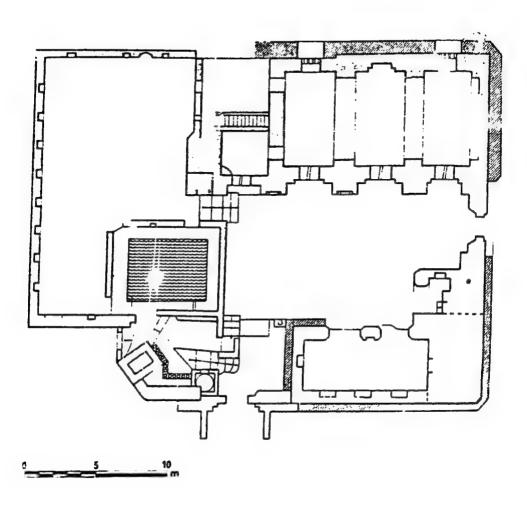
مسقط أفقي للمدرسة السكندرية _ زبيد
